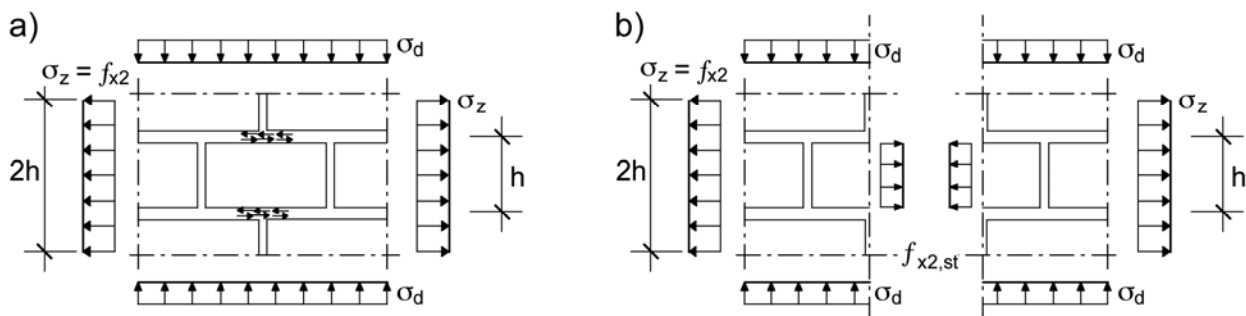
Mauerwerksversagen durch Zugbeanspruchung parallel zur Lagerfuge:
